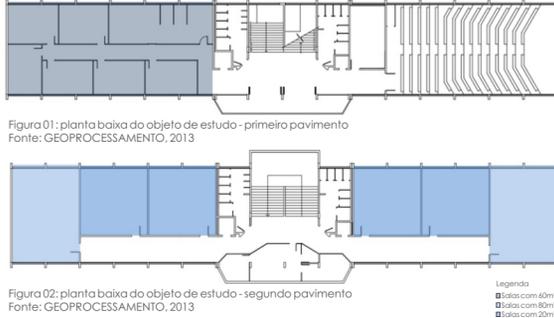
planta baixa do objeto de estudo - primeiro pavimento
